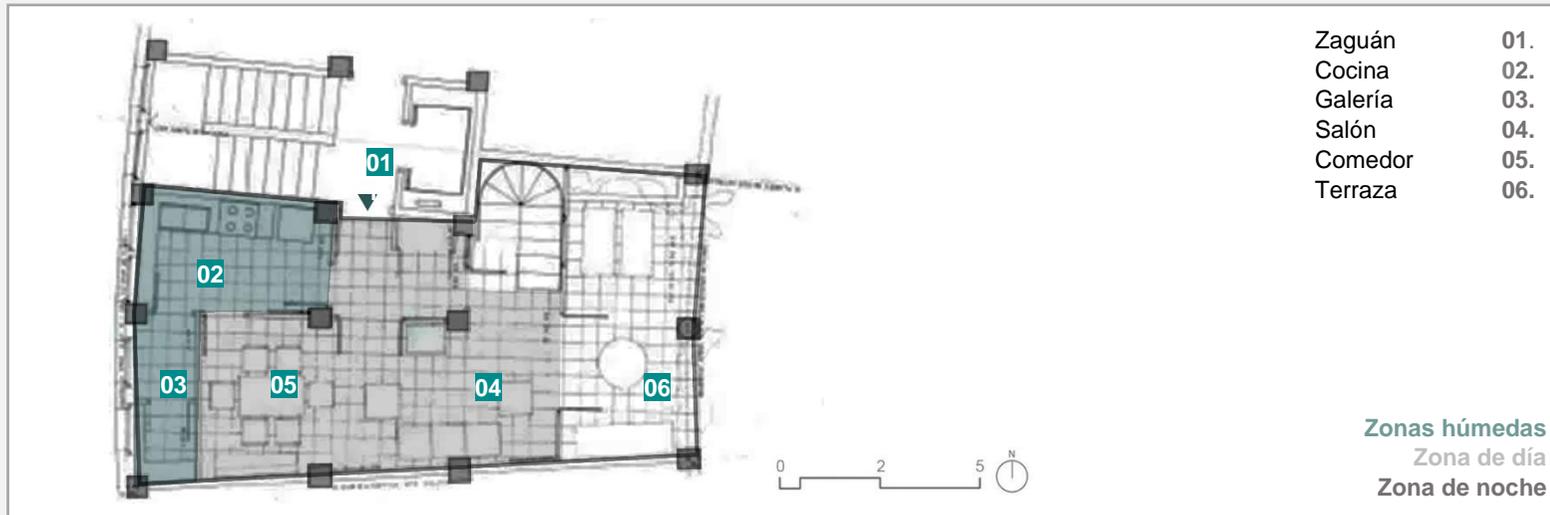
El Ruedo. Planta tipo 3 dormitorios. Planta Baja
